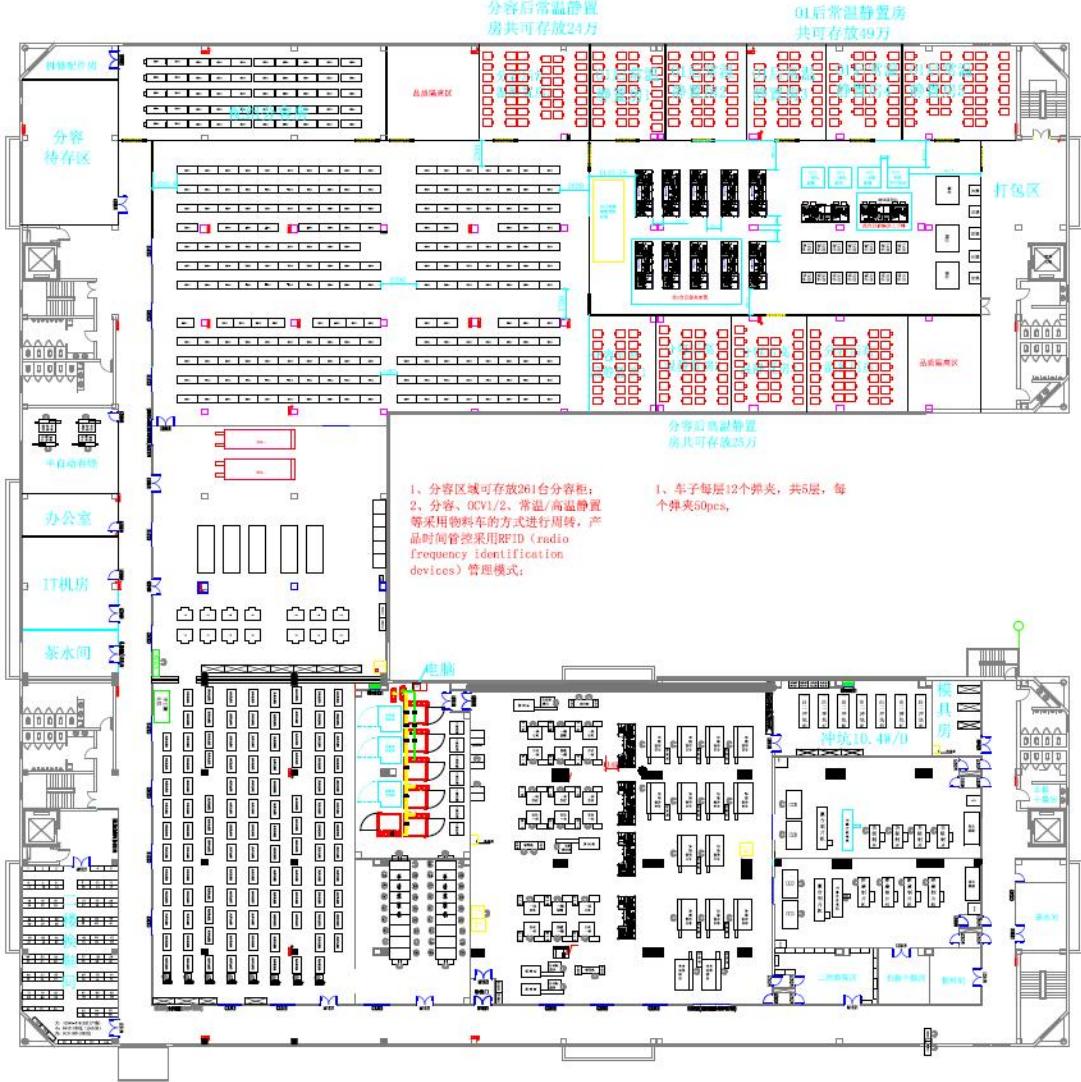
港西大道厂区 AB 栋二楼平面图
